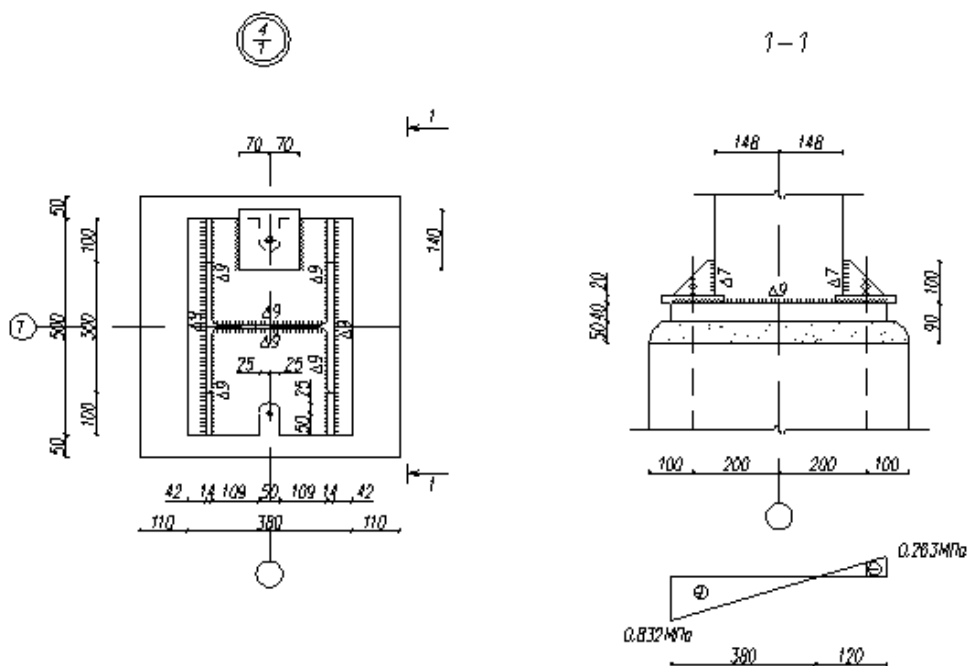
Схема конструкції бази колони та еюра напружень.
